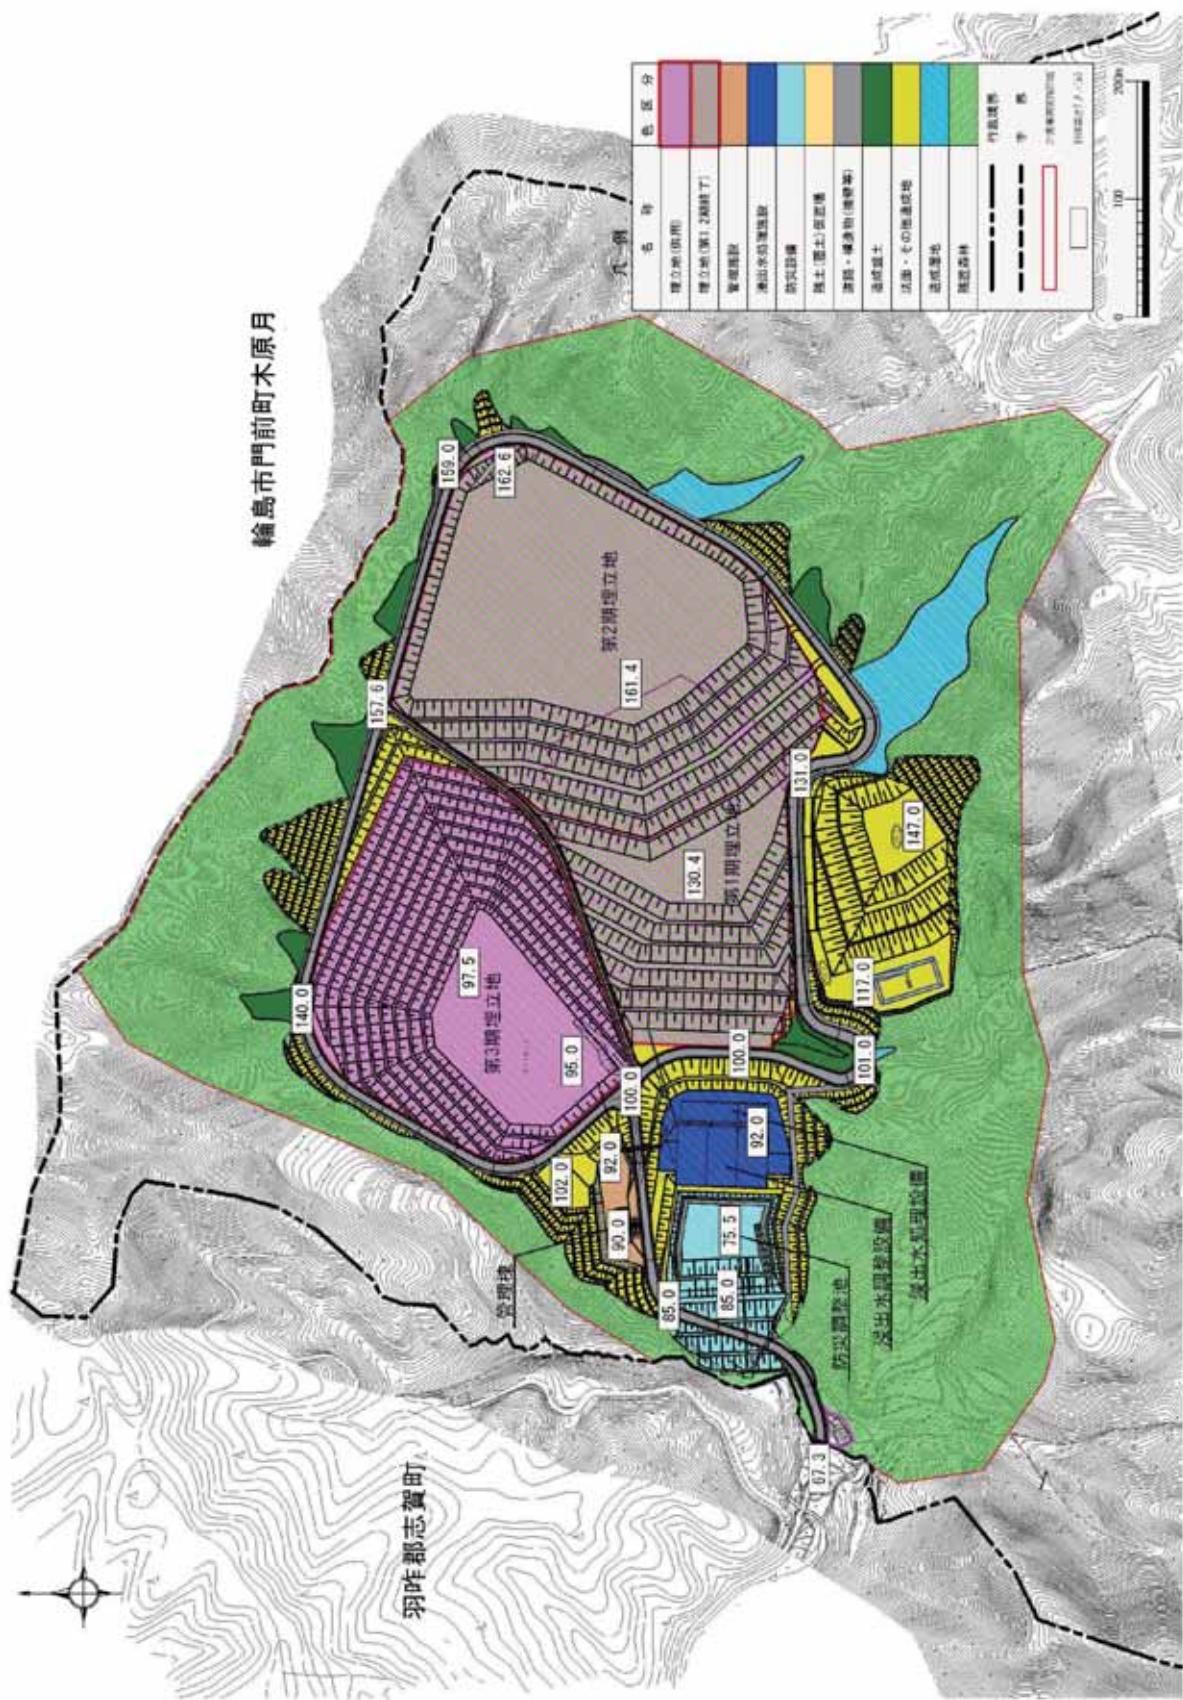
造成・施設配置計画平面図（第3期整備）
